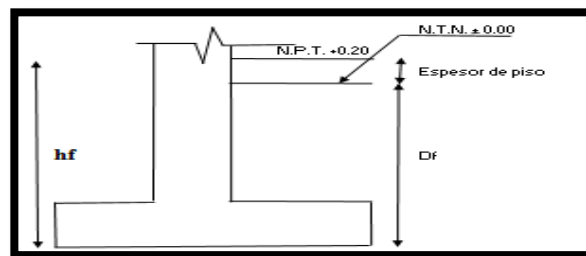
Elevación de una zapata aislada. Fuente: Elaboración propia.
